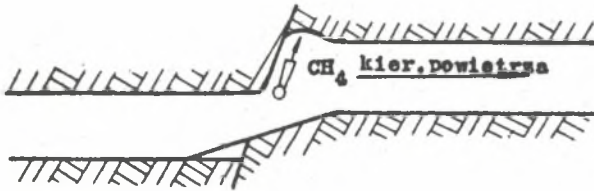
Zabierka z podszkłą hydrauliczną
